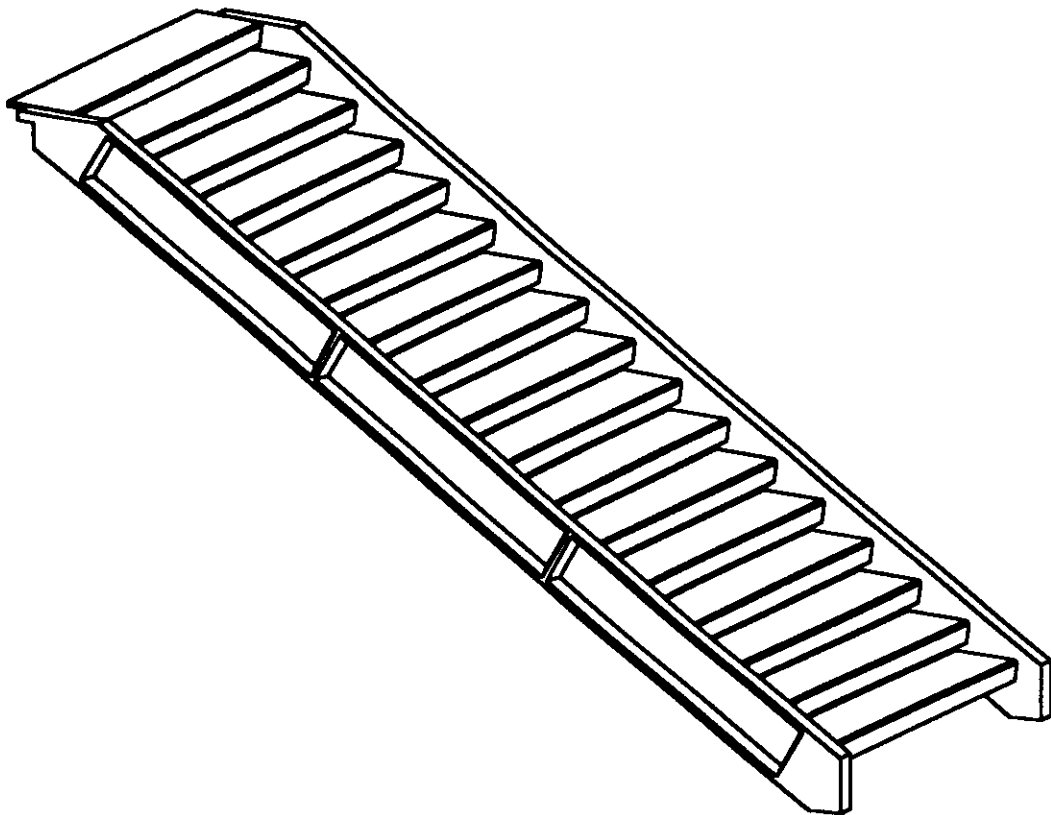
Esquema em perspectiva do conjunto de escada adotado nas edificações de dois pavimentos do sistema de equipamentos sociais.
